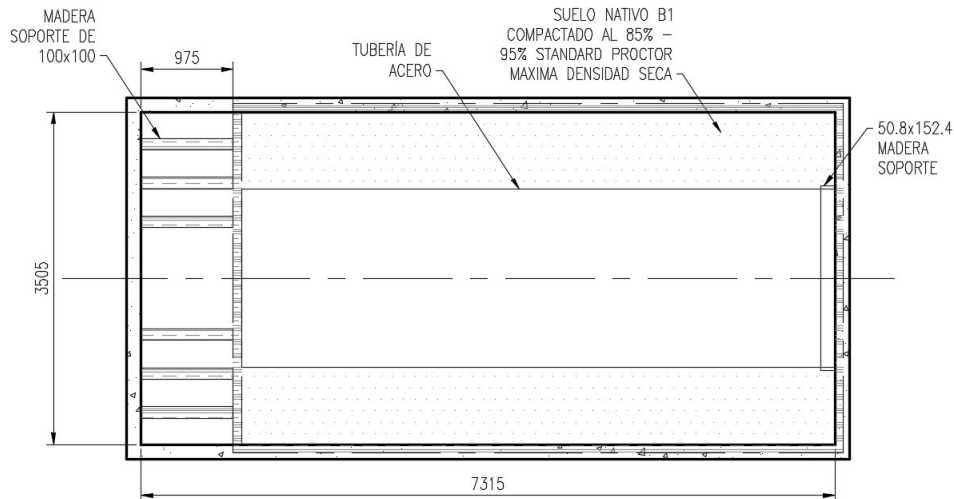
Vista de planta de la instalación para la Prueba 1a (En mm). Adaptado de (SHARMA, 2013).
